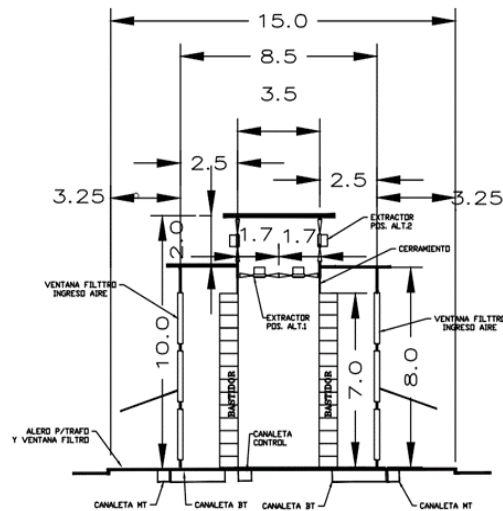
Vista en corte transversal del edificio del RM
